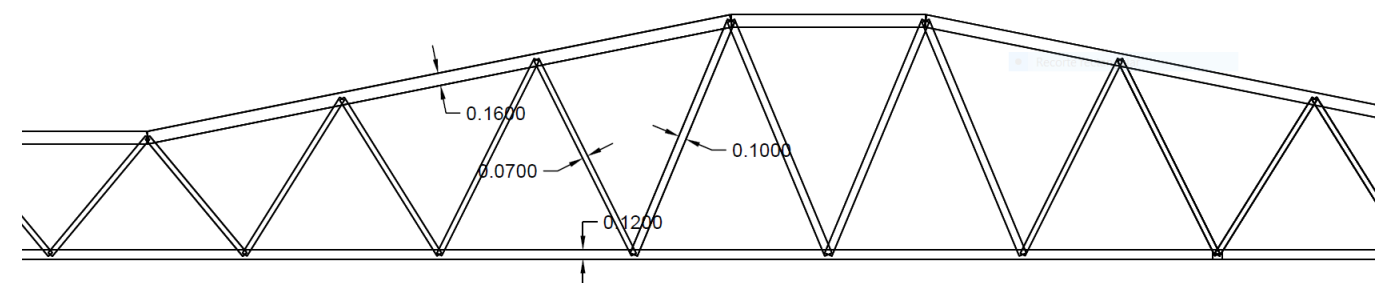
Anchos perfiles (Fuente: elaboración propia).
